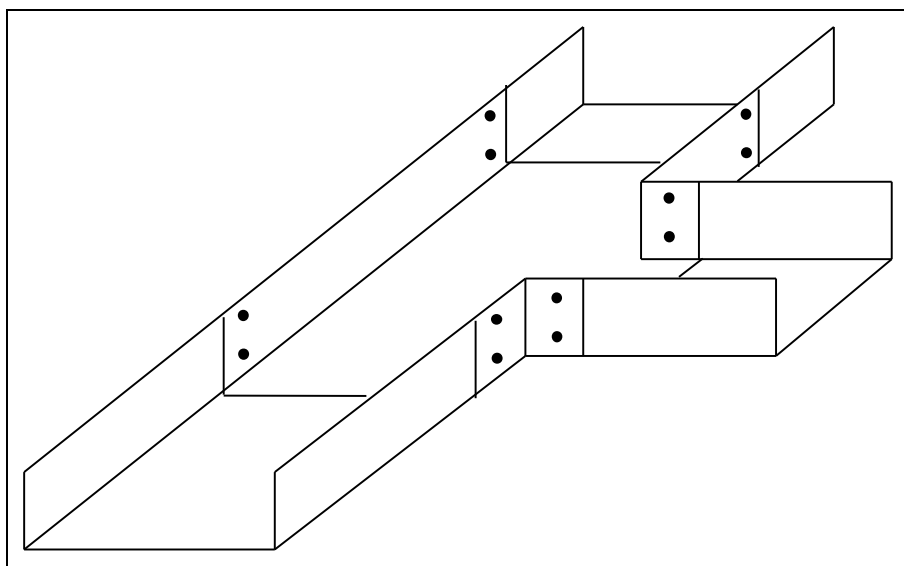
Exemplo de ligação entre esteiras de cabos em ângulo reto, estrutura em T
